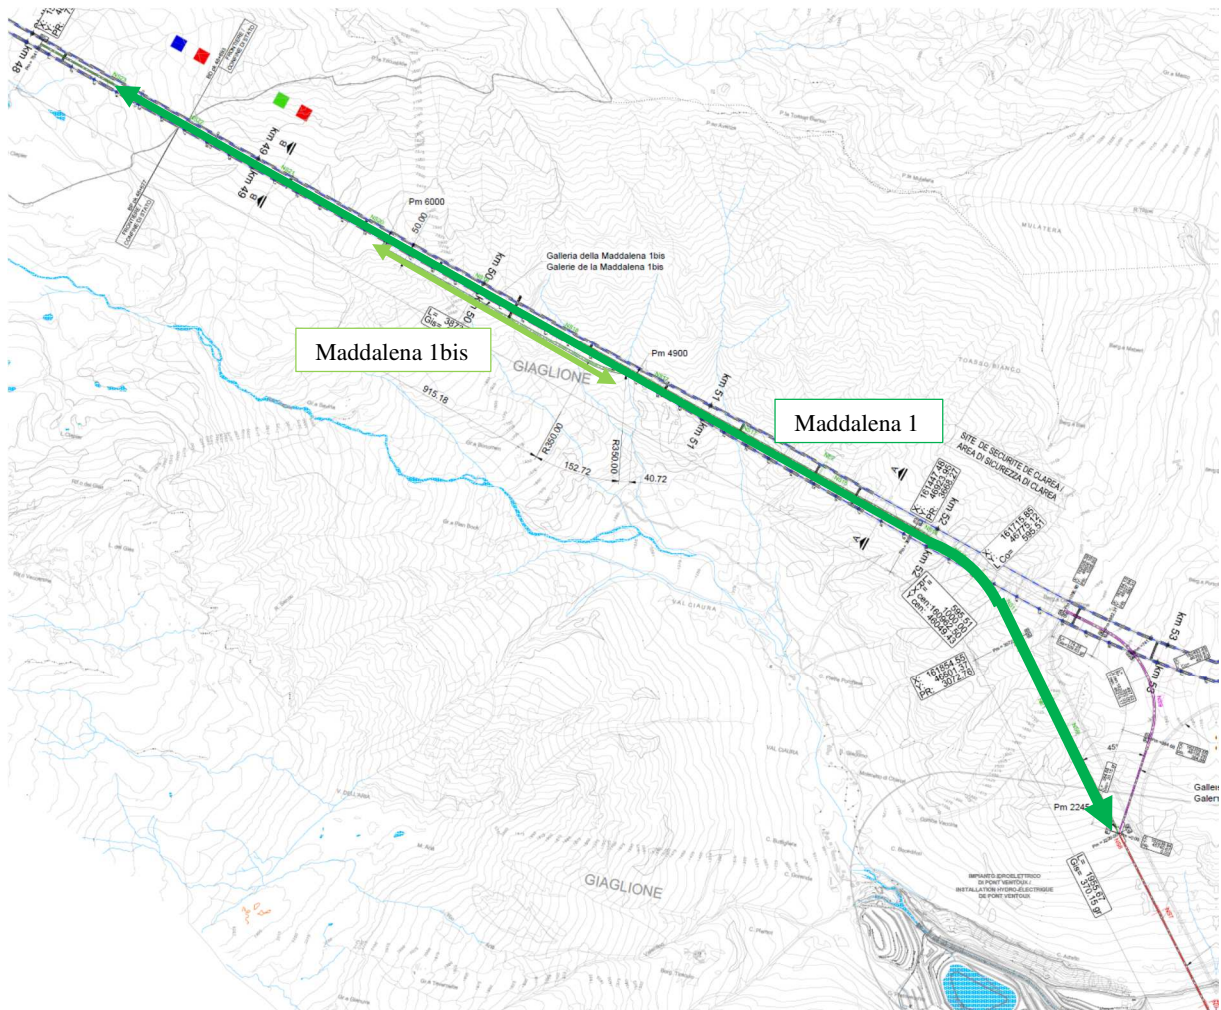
Planimetria delle zone di stoccaggio in Maddalena 1 e Maddalena 1bis (PRV_C3A_3803_26-48-10)
